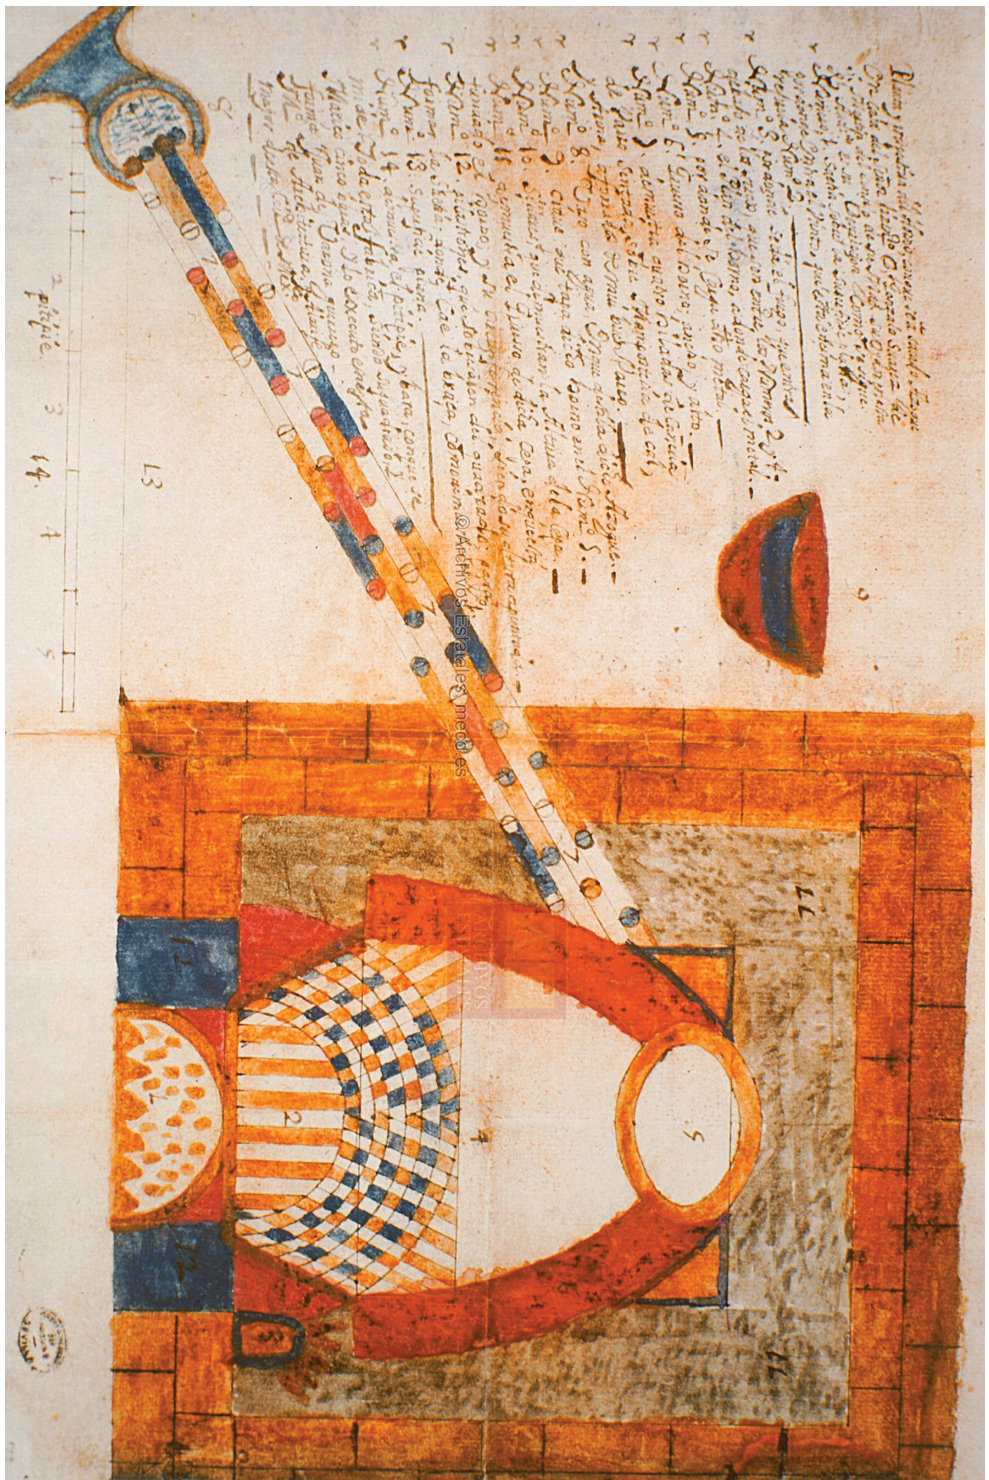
Planta y perspectiva del horno de aludales de las minas de Chilapa³⁷
